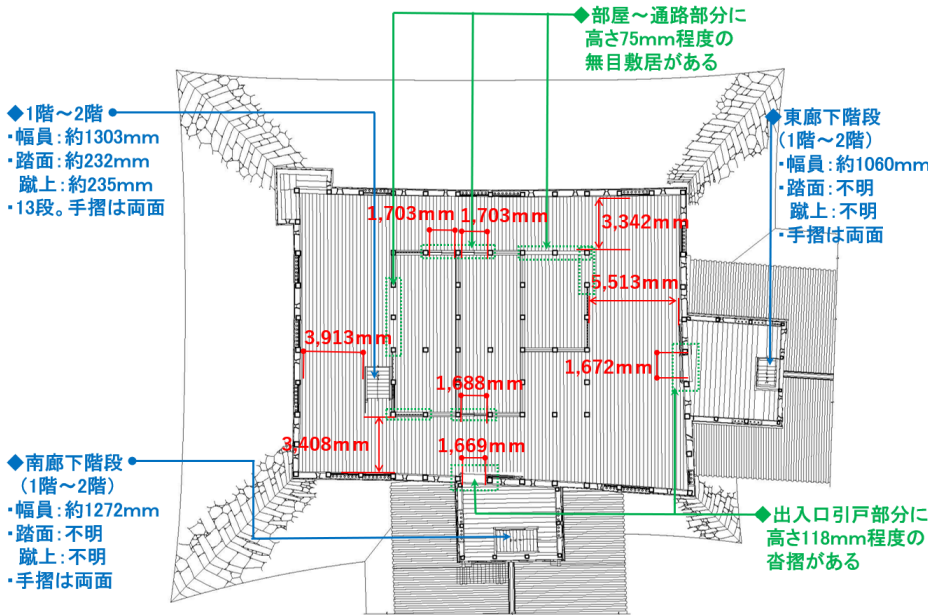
天守 1 階平面図及び東廊下・南廊下 2 階平面図（復元原案）
